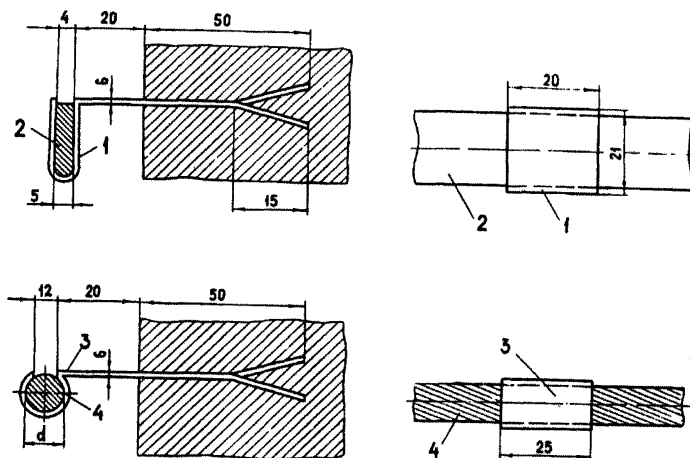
Схема крепления заземляющих проводников в камере с бетонной крепью:
